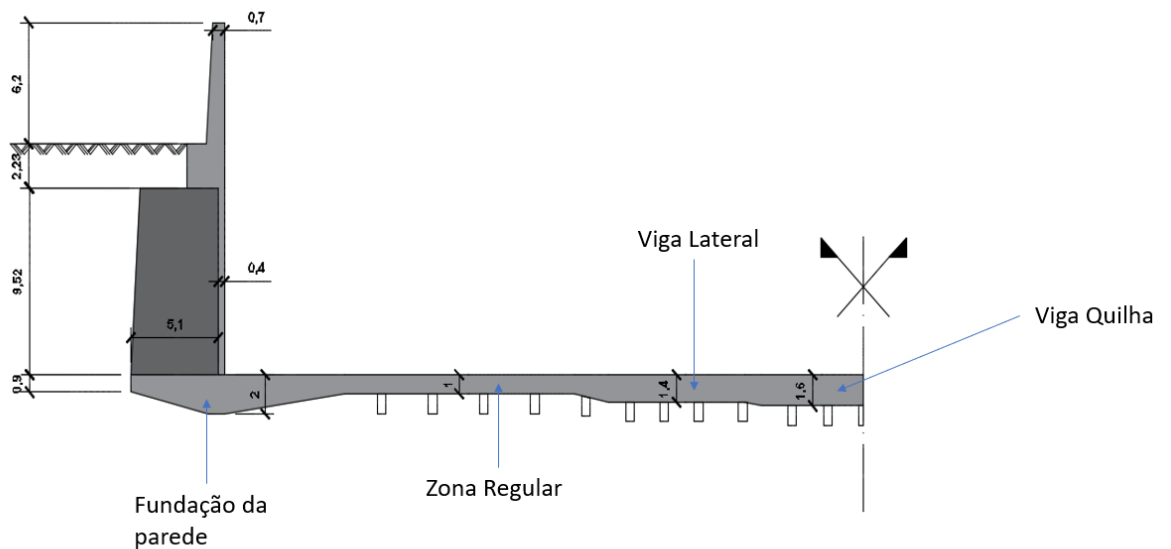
Corte transversal tipo dos painéis 1 a 11.
